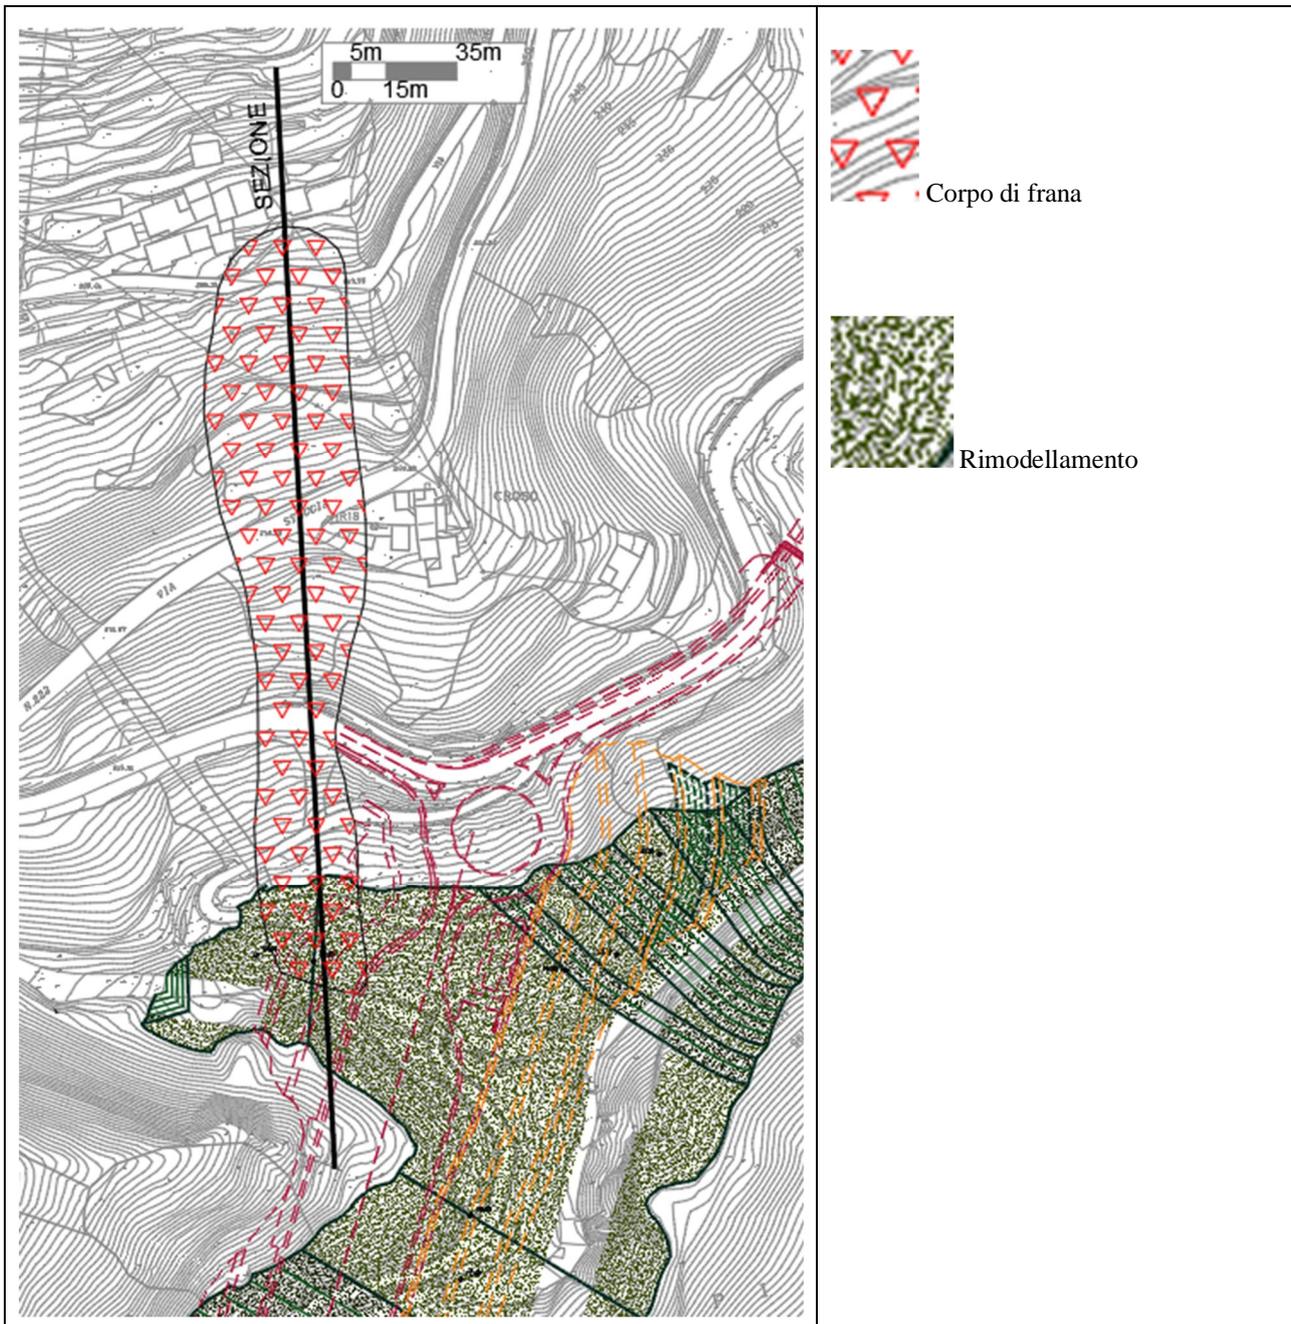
Stralcio planimetrico con l'indicazione della sezione analizzata
